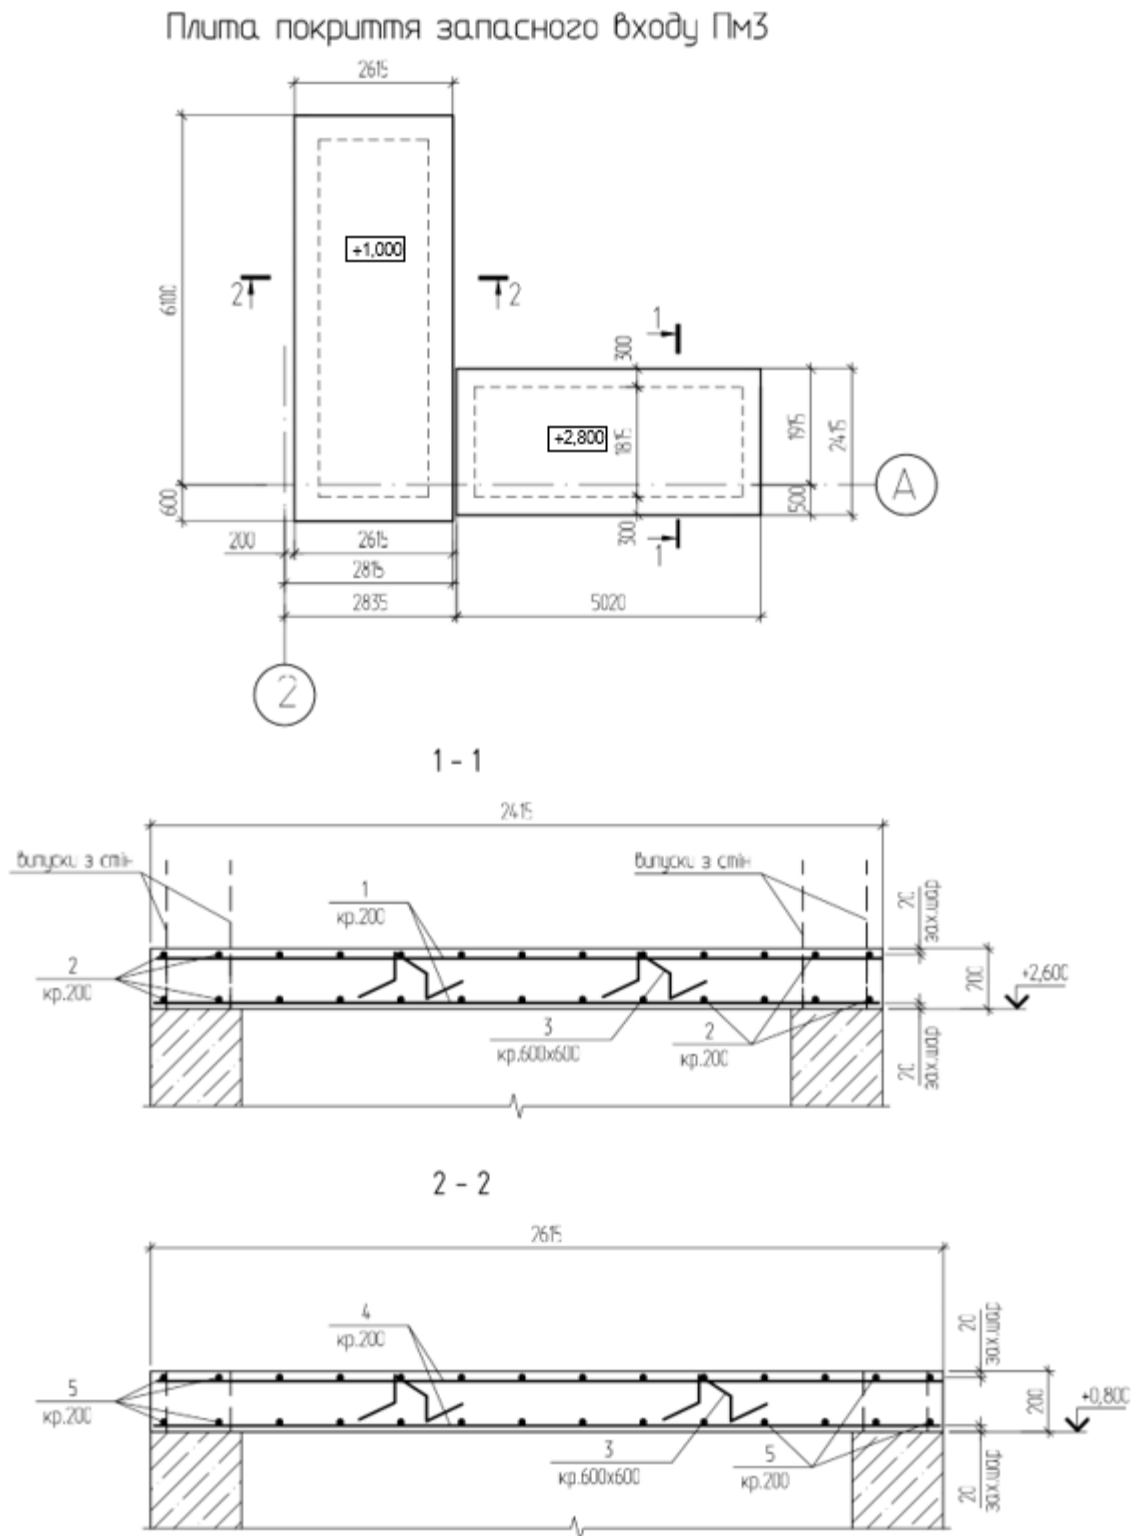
Монолітна залізобетонна плита перекриття з важкого бетону
